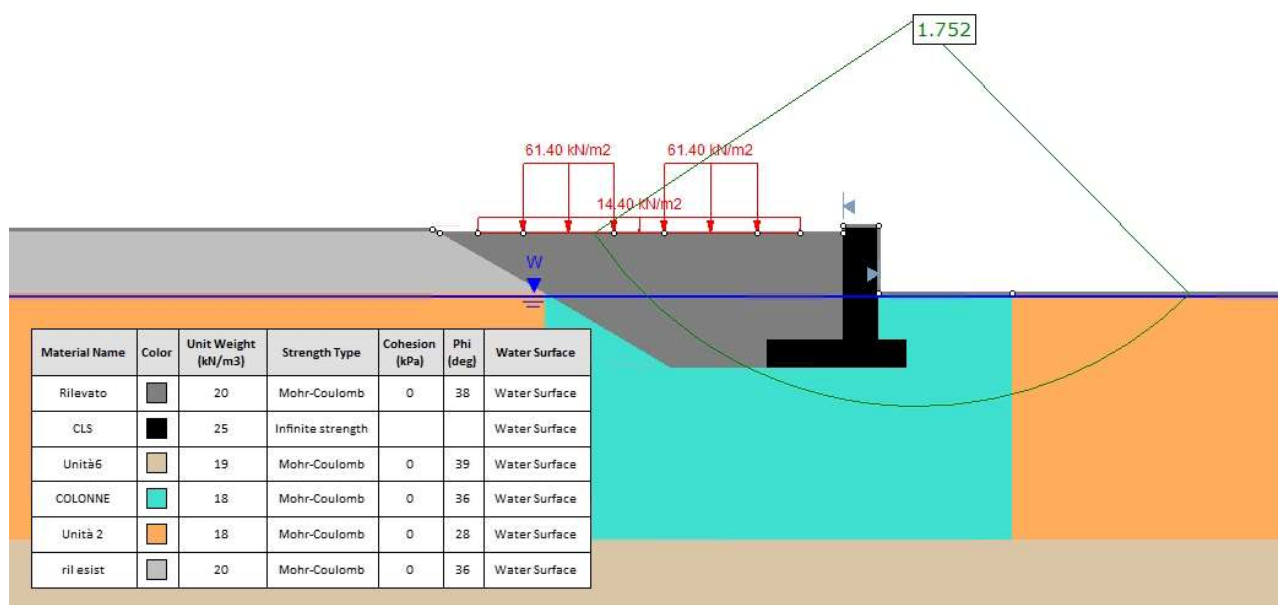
Sezione A - Analisi SLU in campo statico DA1C2
